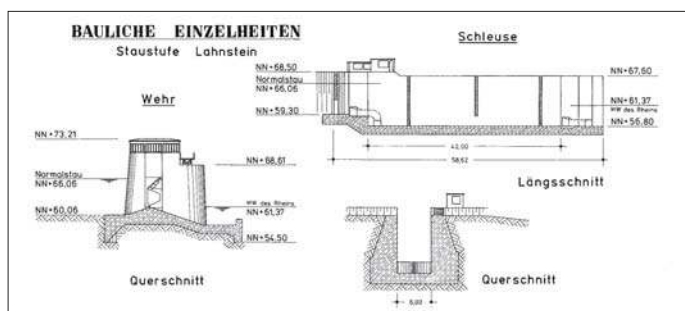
bauliche Details Staustufe Lahnstein (Quelle: WSA Koblenz)
